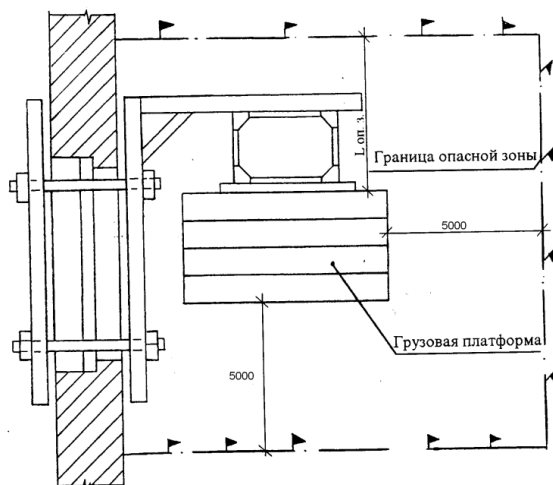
Опасная зона при работе грузового строительного подъемника
